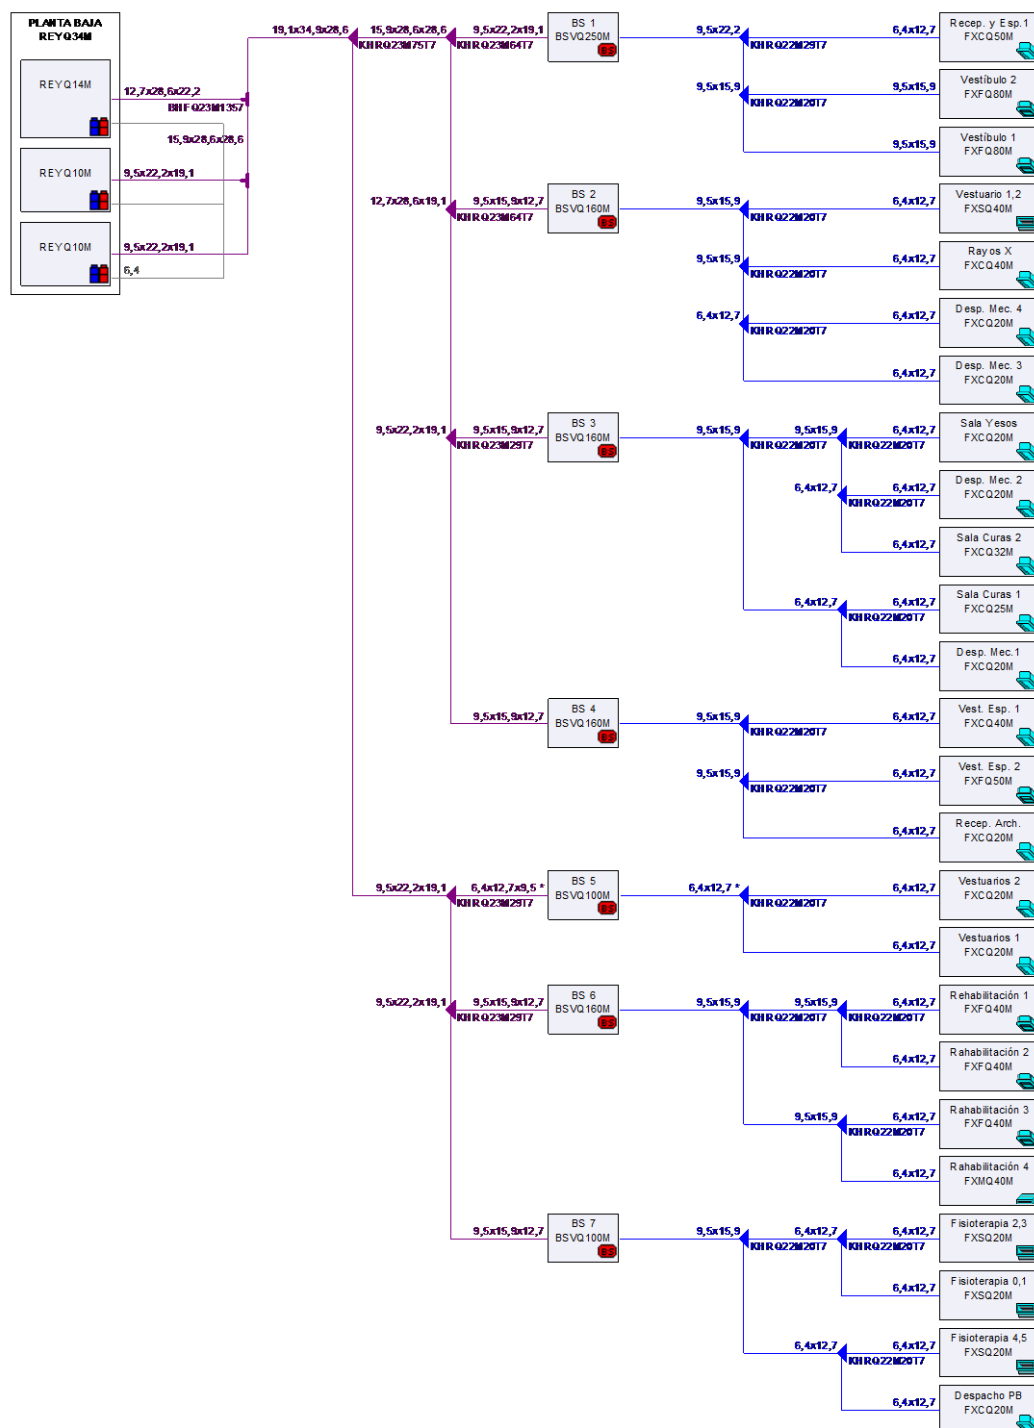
Esquema conexión de tuberías frigoríficas VRV. PLANTA BAJA
